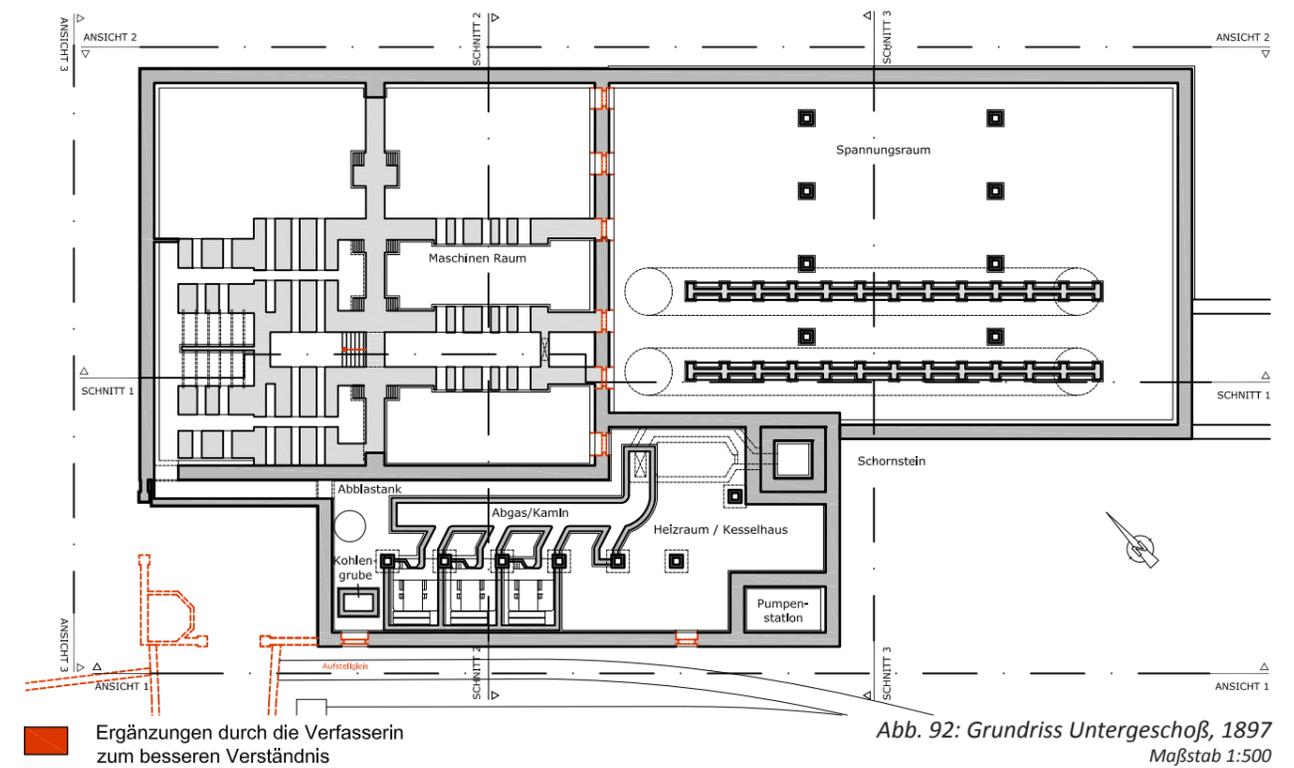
Grundriss Untergeschoß, 1897
